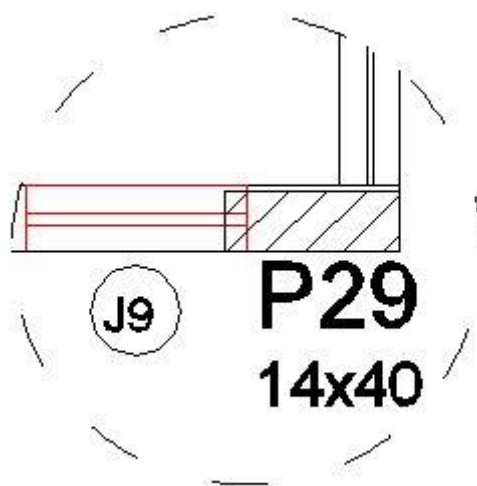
Conflito do Pilar P29 com a esquadria J9, em planta
